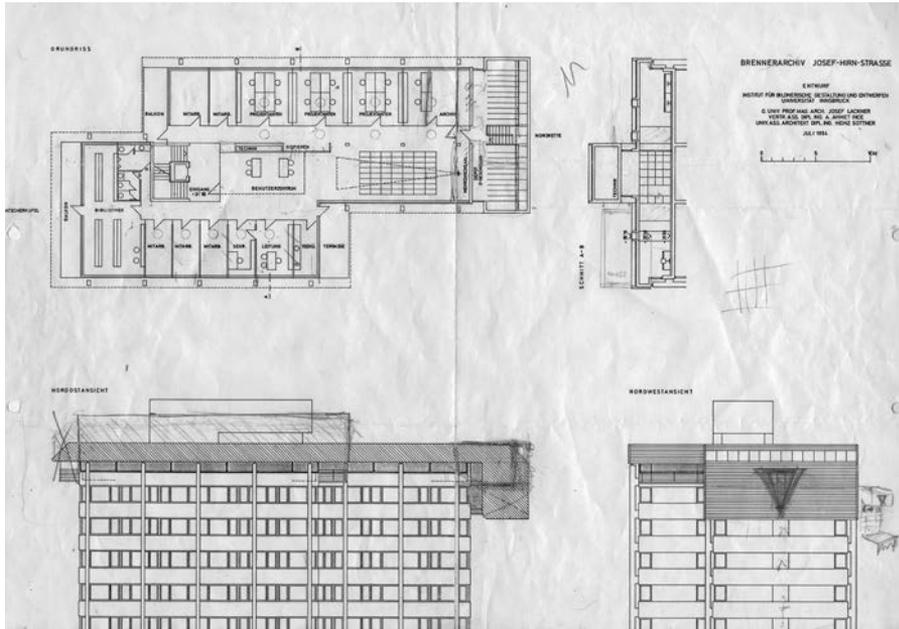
Josef Lackner: Entwurf, noch mit zwei-geschossigem Depotraum, Juli 1994 (Grundriss, Schnitt, Ansichten). Brenner-Archiv.
